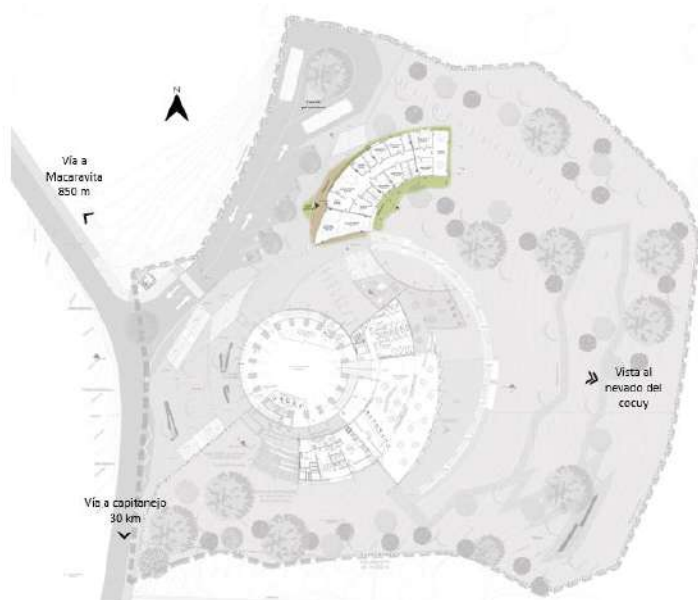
Planta nivel +/- 0.0m edificio norte zona de habitaciones
